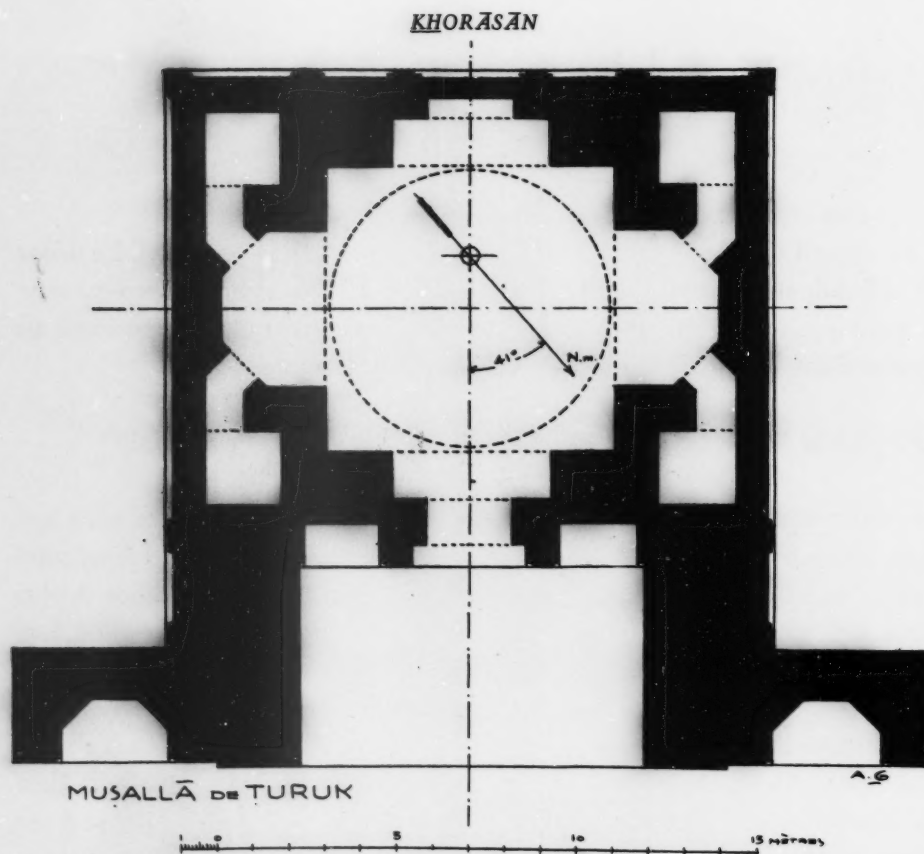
TURUK. PLAN DU MUŞALLĀ
